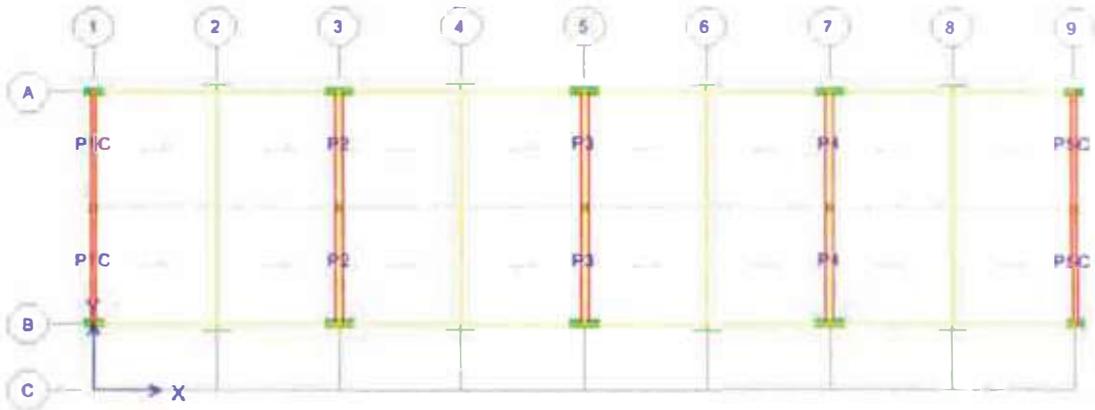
Vista en planta del Módulo 4A-2P con muros exteriores de concreto (P1C y P5C).
